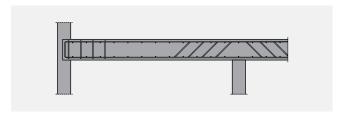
Flachdecke mit Bügeln und Schrägaufbiegung
